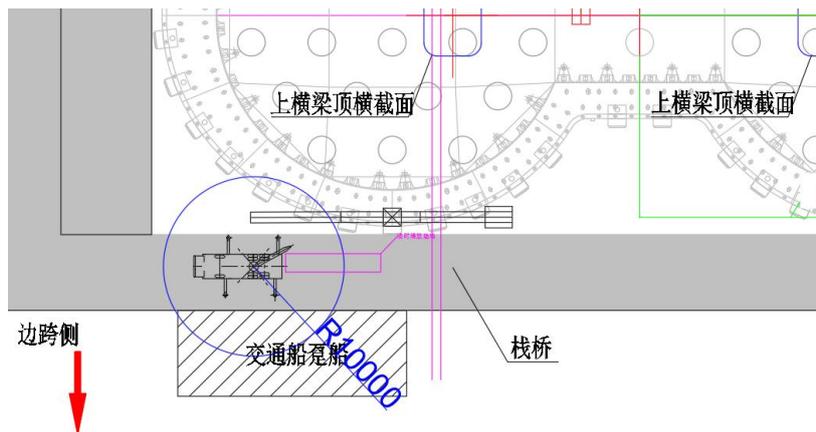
5#塔机起重臂臂节 2 拆除平面示意图
